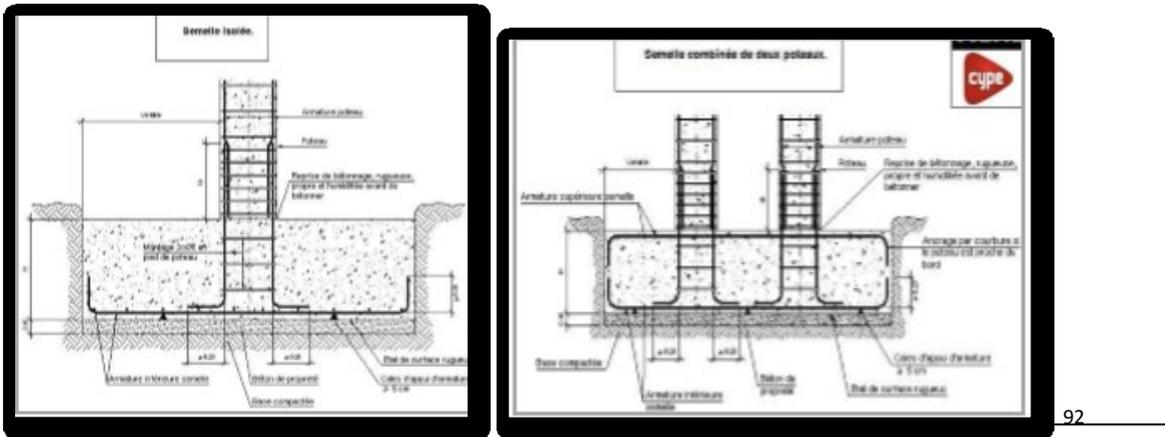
Schéma représentant d'une semelle combinée de deux poteaux.¹
